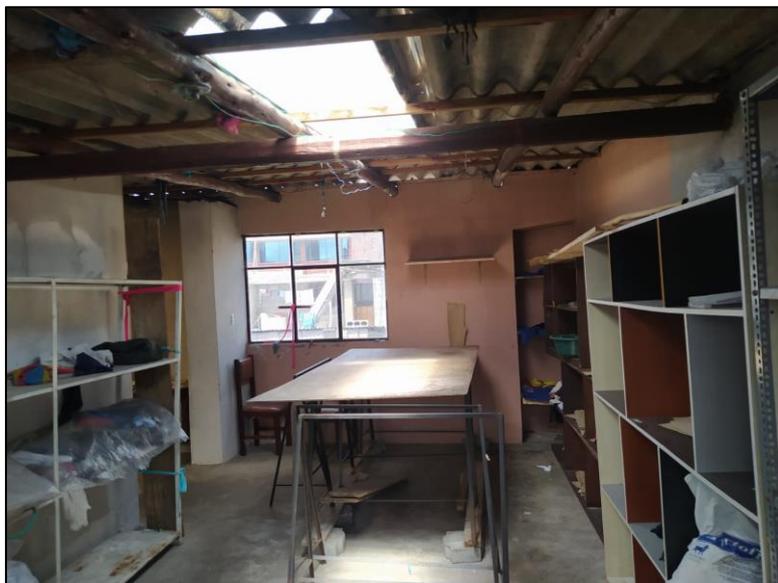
SEGUNDA PLANTA ALTA - TALLER.
